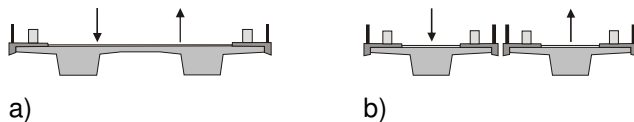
Brücken mit Straßenquerschnitten von nicht mehr als einem Fahrstreifen je Fahrtrichtung
